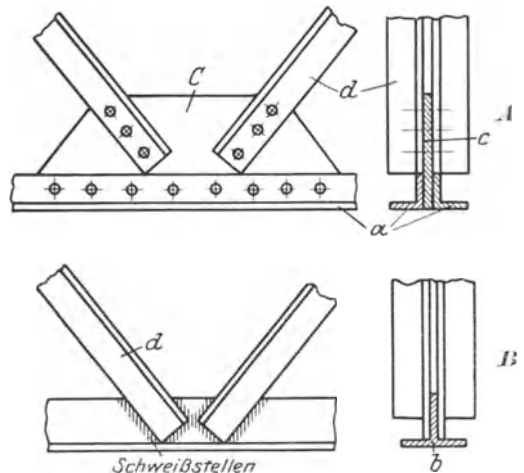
Unterschied zwischen Nietung und Schweißung.
